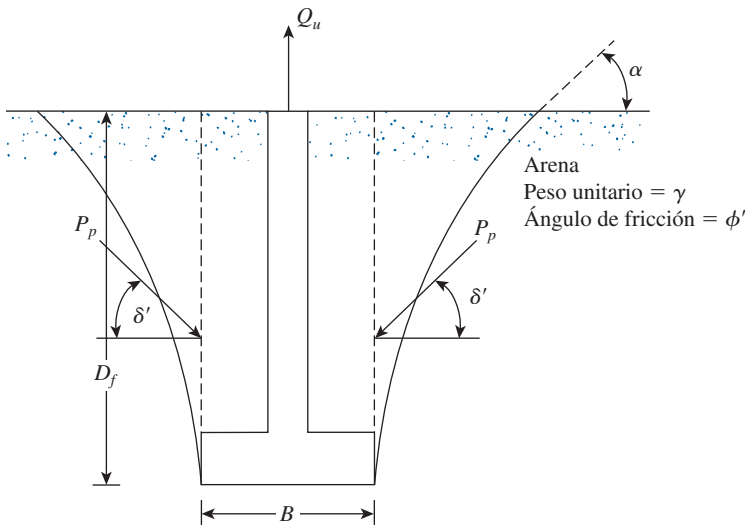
Cimentación superficial continua sometida a levantamiento.
